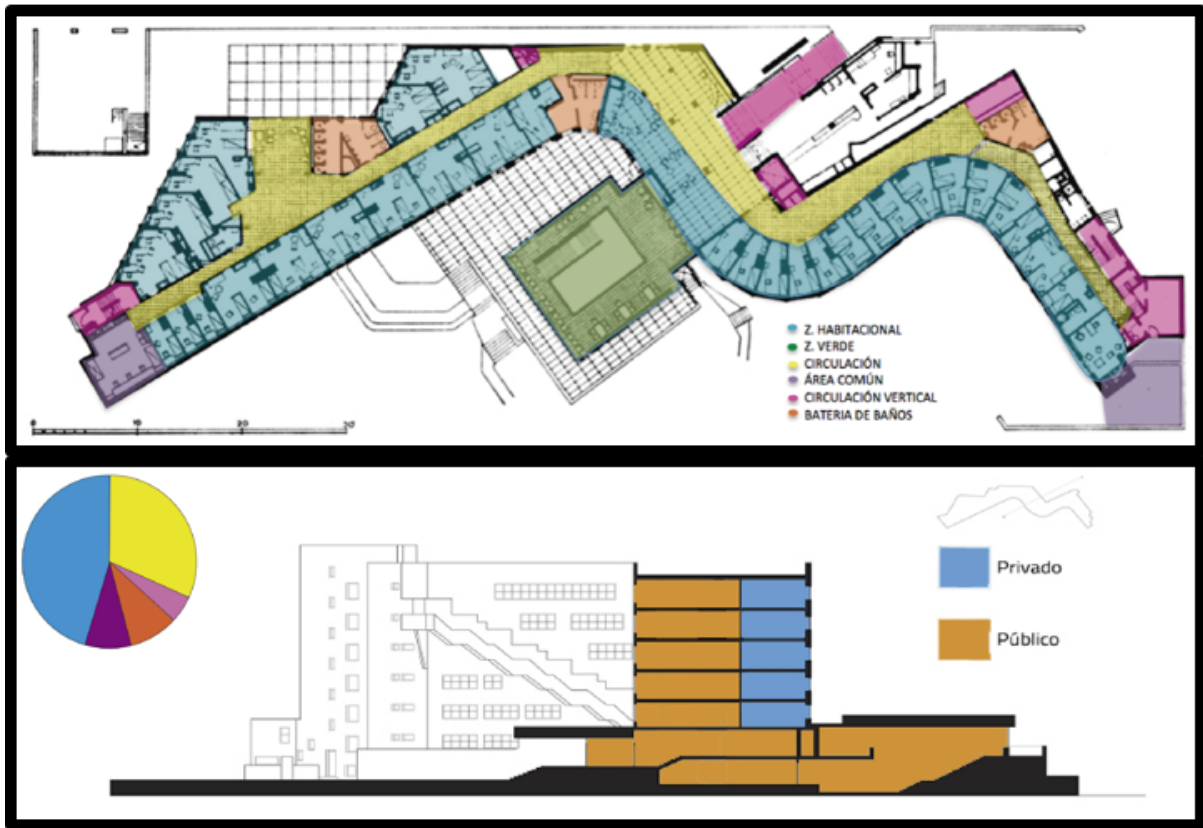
Planta residencia estudiantil Baker house Alvar Aalto.
